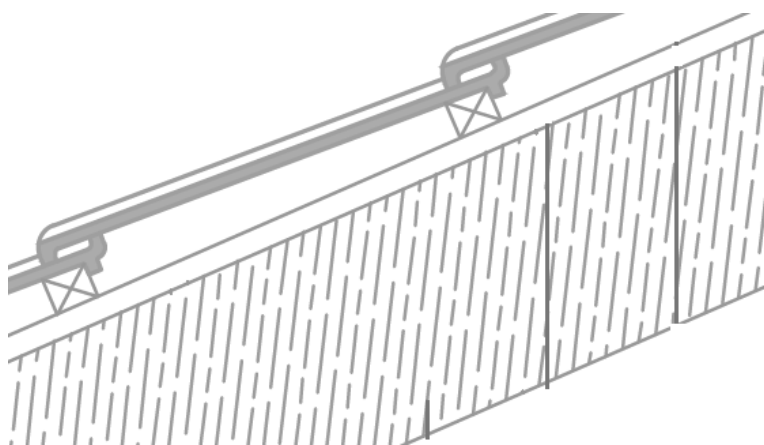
sistema de cubierta inclinada con teja plana sobre rastreles con pares de madera, encontrado en el edificio de referencia situado en Alicante. Autora.
